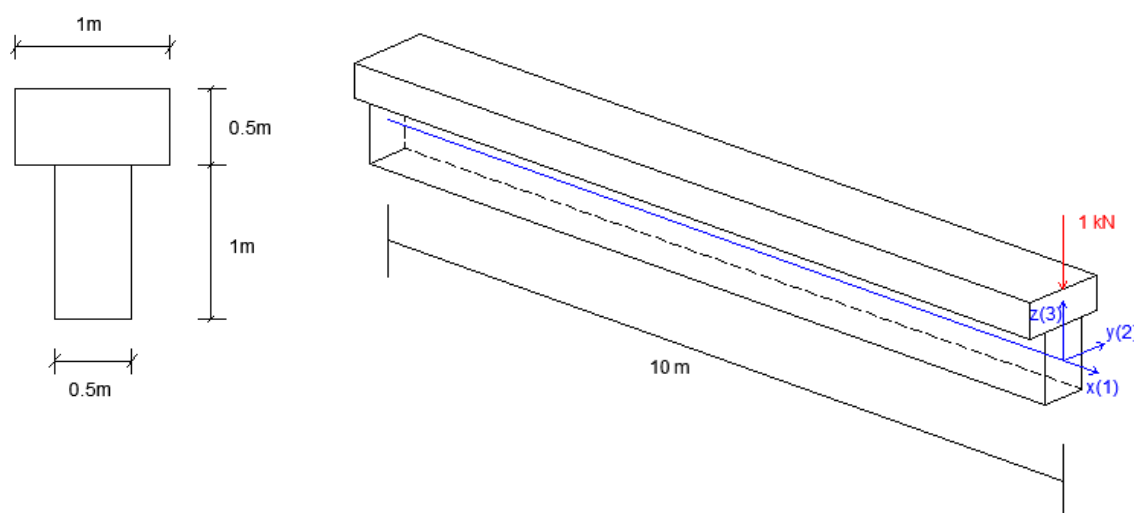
Configuração inicial da laje vigada em consola. Referencial adotado.
